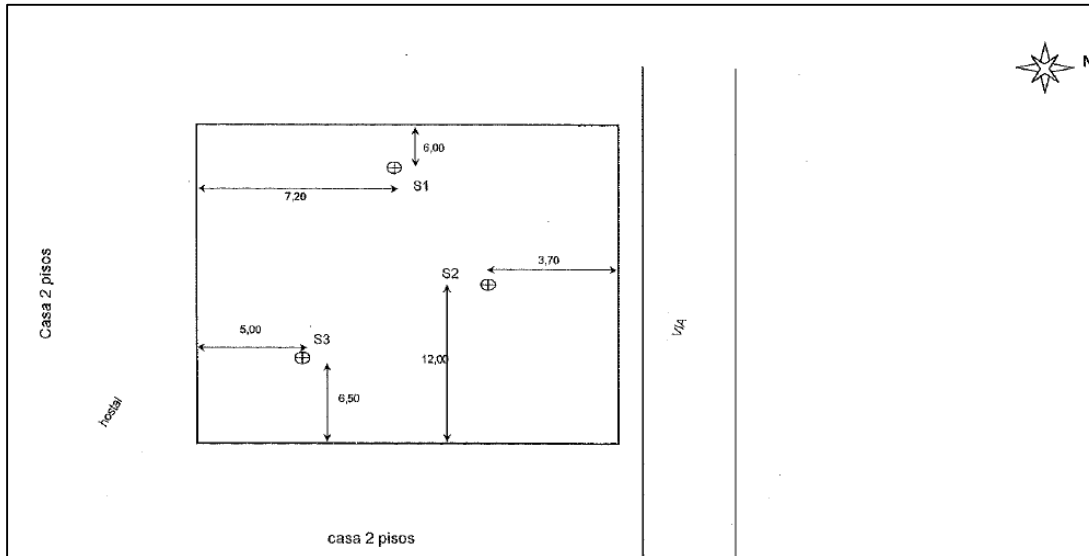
Vista en planta de los sondeos realizados en la estructura (Useche Macías, 2002)
